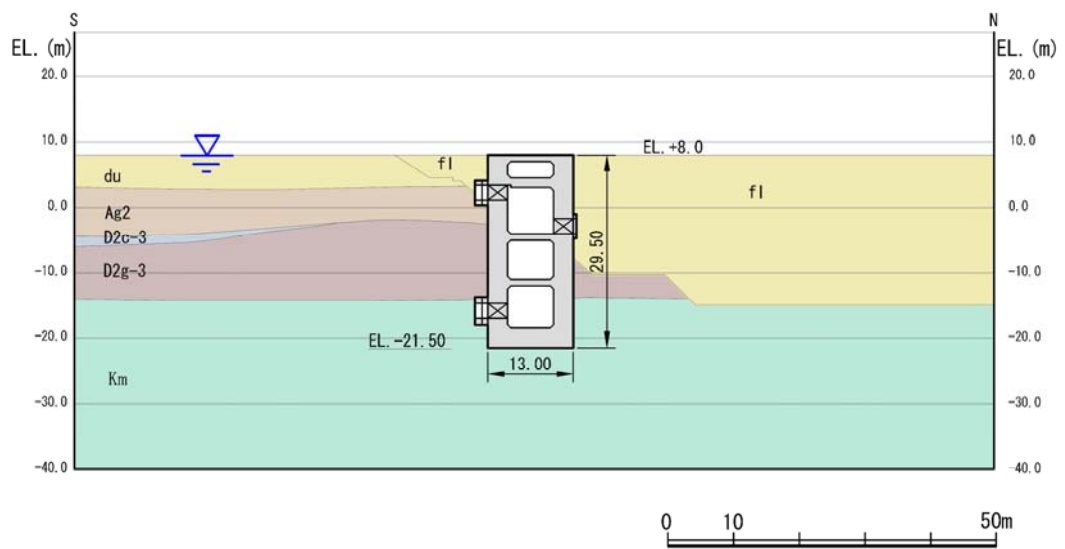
(4) 常設低圧代替注水系ポンプ室地質断面図 (B-B断面)
